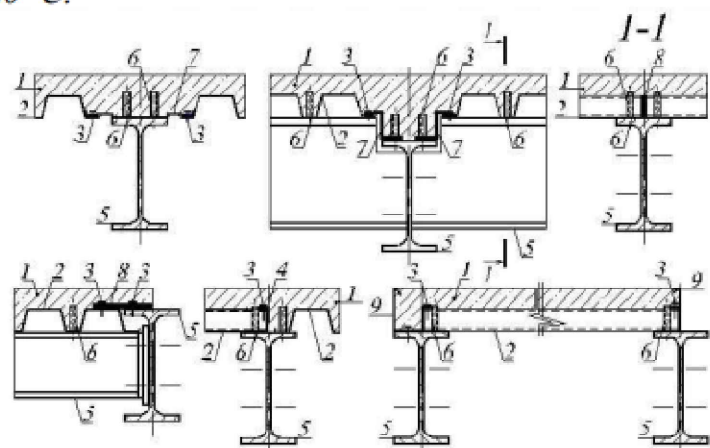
Схеми стикування сталевого профільованого листа на балки перекриття: 1 - монолітний бетон плити перекриття, 2 - сталевий профільований лист, 3 - самонарізний гвинт, 4 - г - подібний націльник із оцинкованої сталі, 5 - балка перекриття, 6 - анкерний стержень із тонкостінної труби, 7 - націльник із оцинкованої сталі, 8 - заглушка із пластику, 9 - заглушка із оцинкованої сталі.
